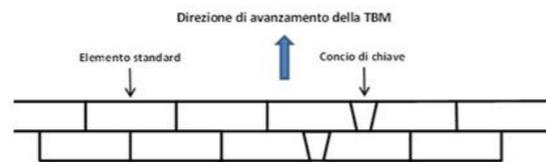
Tipica disposizione dei conci rettangolari e trapezoidali
